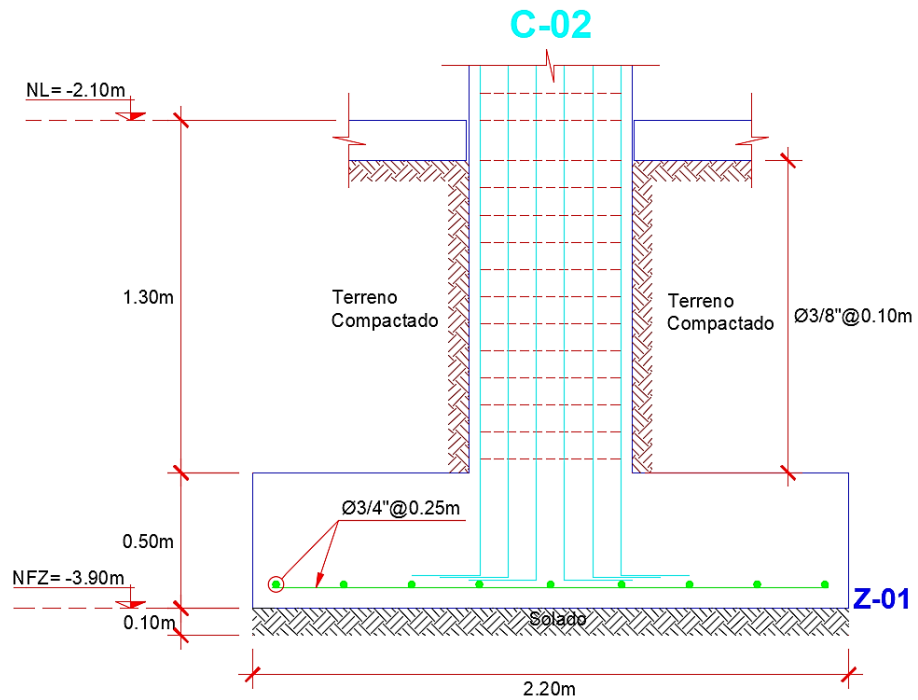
Detalle del refuerzo en concreto armado vista en elevación (Zapata-Geotextil)
